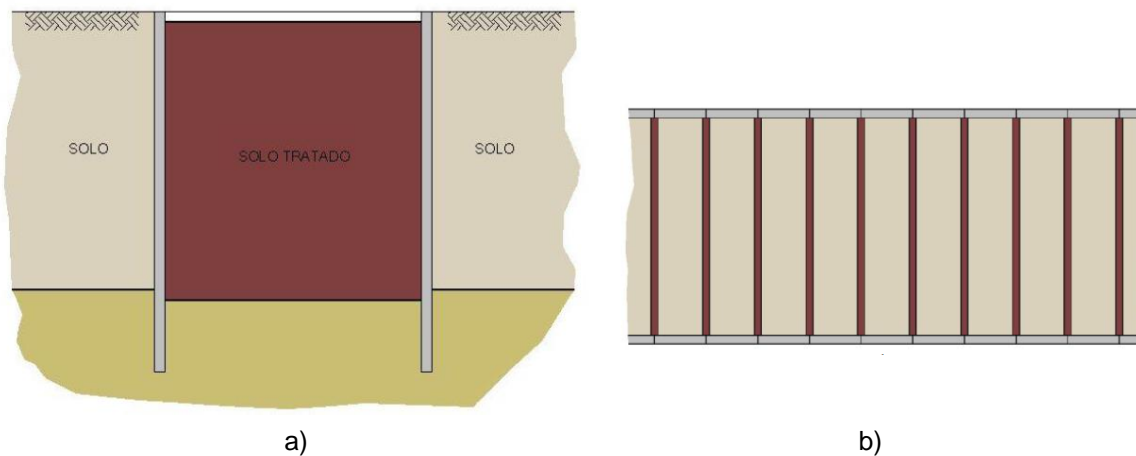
Travamento transversal até ao topo das paredes periféricas com painéis CSM: a) corte transversal à escavação; b) planta (Matos Fernandes, *et al.*, 2010).
